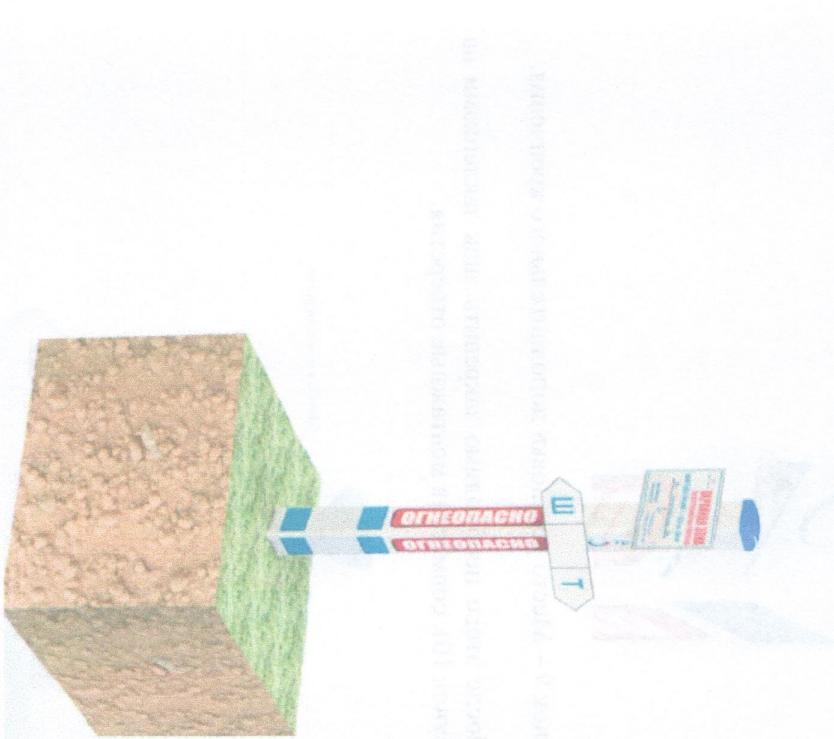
Общий вид ИПЗ.СК.Г с дополнительным опознавательным знаком «Угол поворота».
